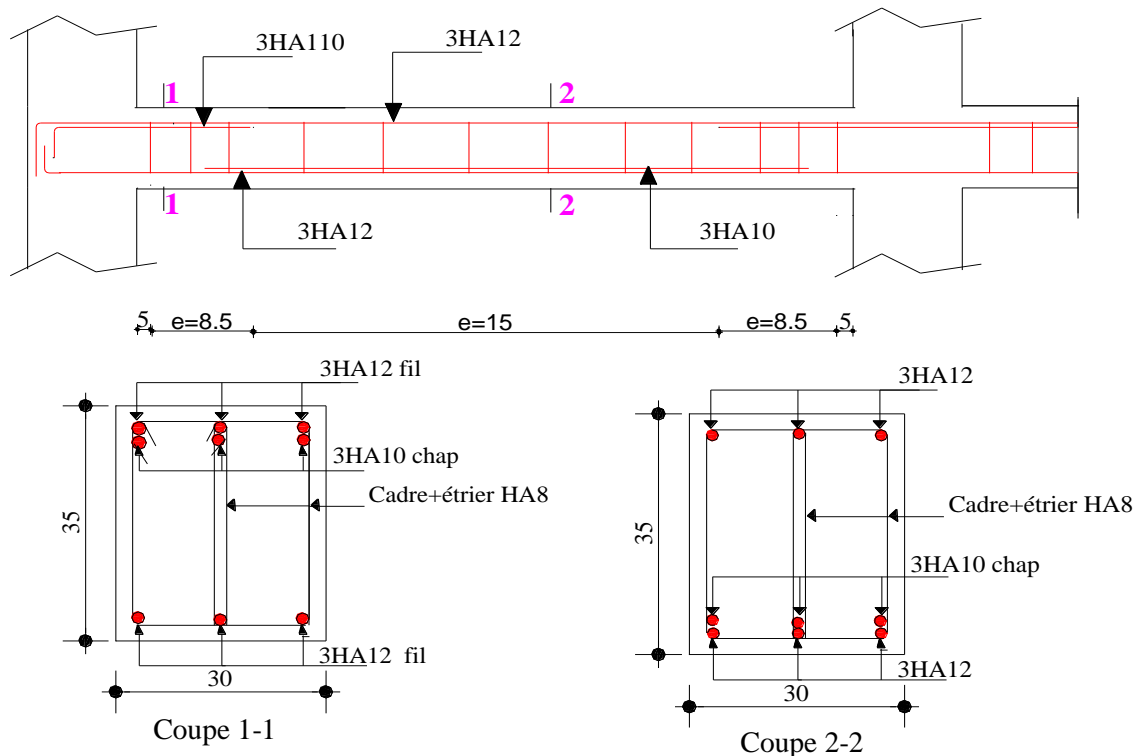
Schéma de ferrailage d'une poutre secondaire.
